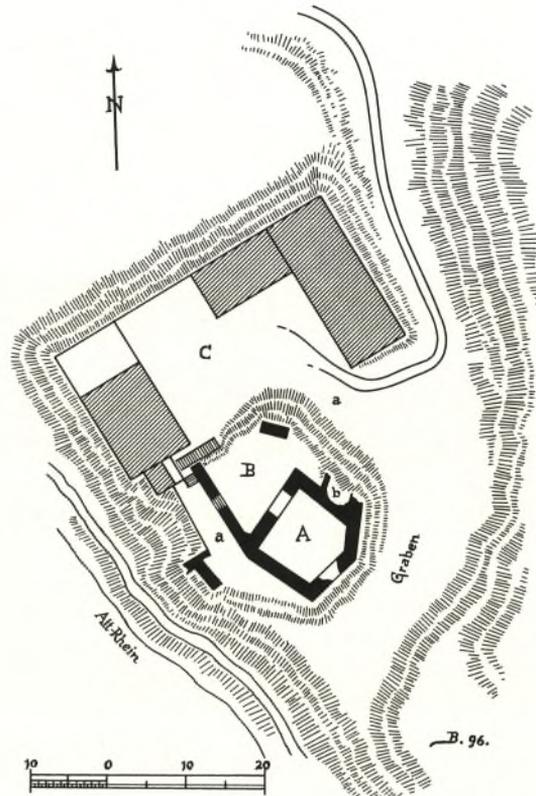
Burg Sponeck. – Plan der mittelalterlichen Burg
